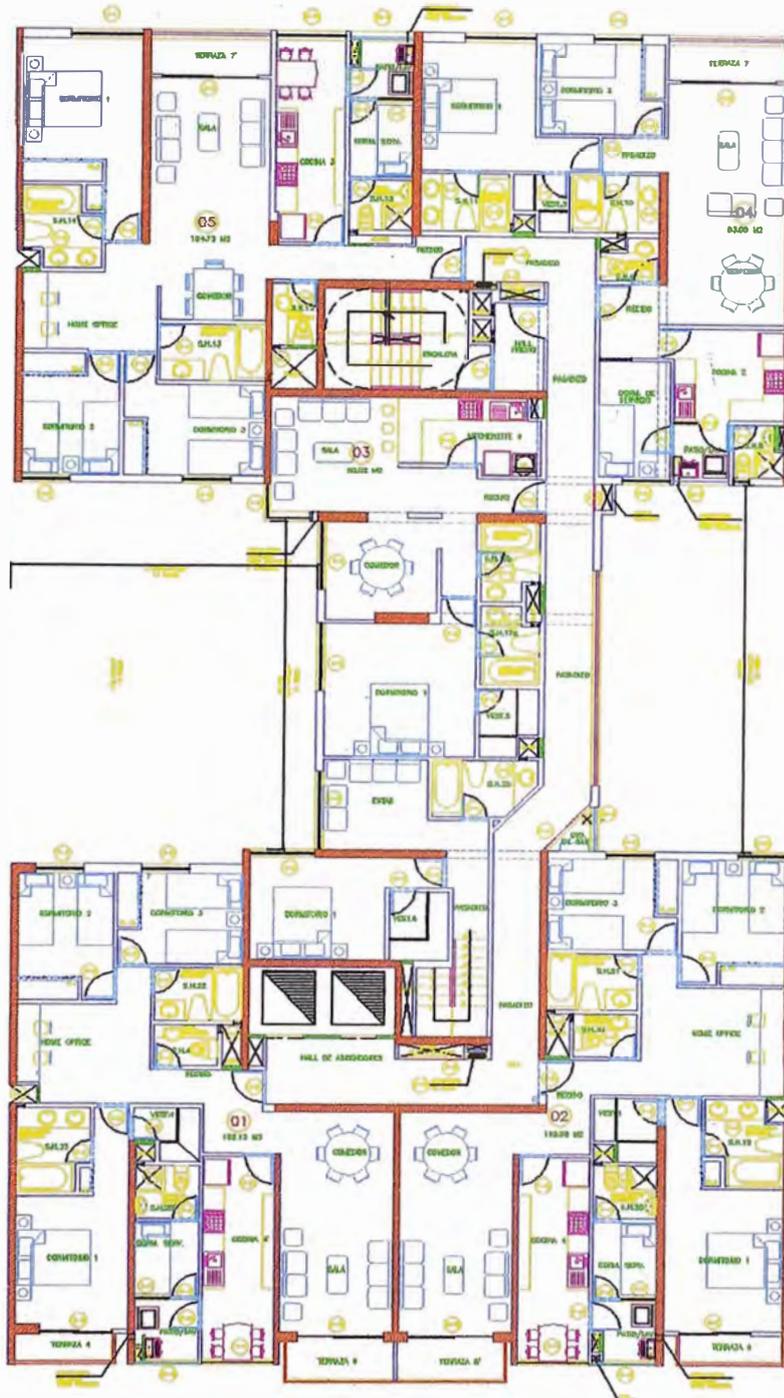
Vista en planta del piso N° 3 del edificio de la obra
